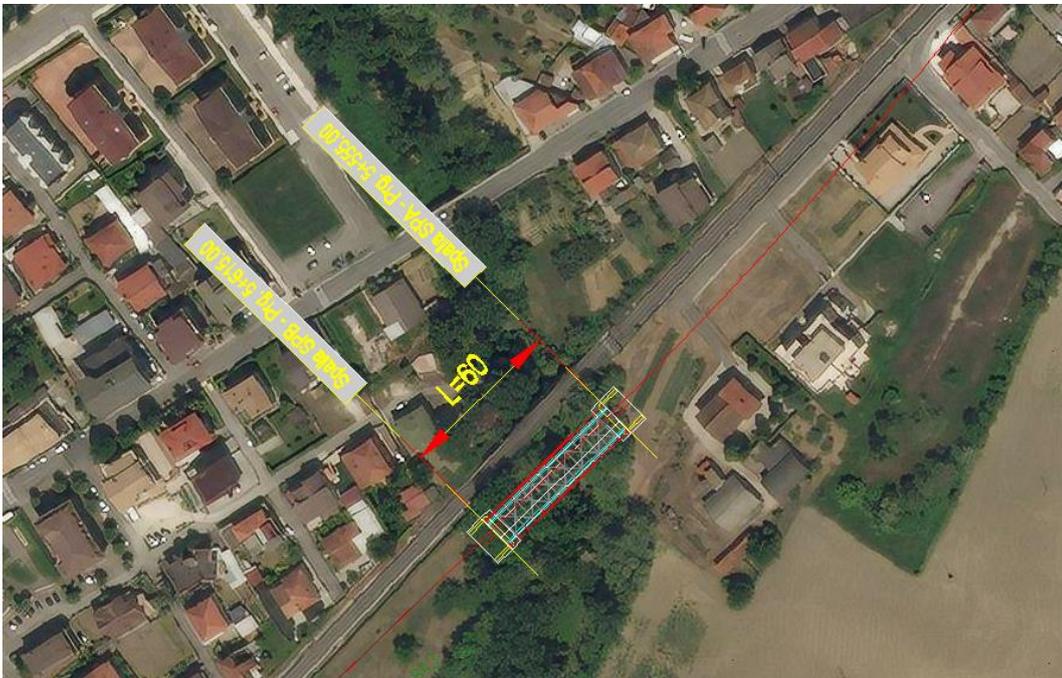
VI03 – Posizionamento su ortofoto rispetto alla linea esistente
